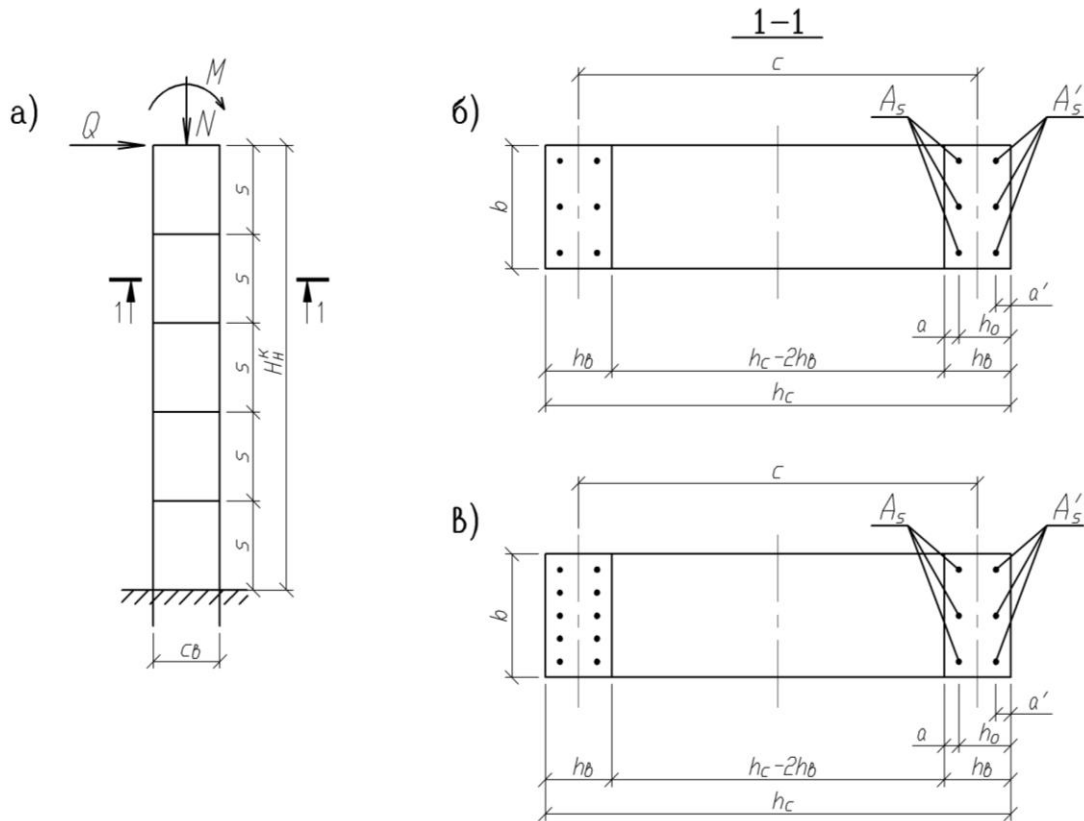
К расчету подкрановой части колонны в плоскости поперечной рамы: а – расчетная схема; б – поперечное сечение средней колонны; в – то же крайней
